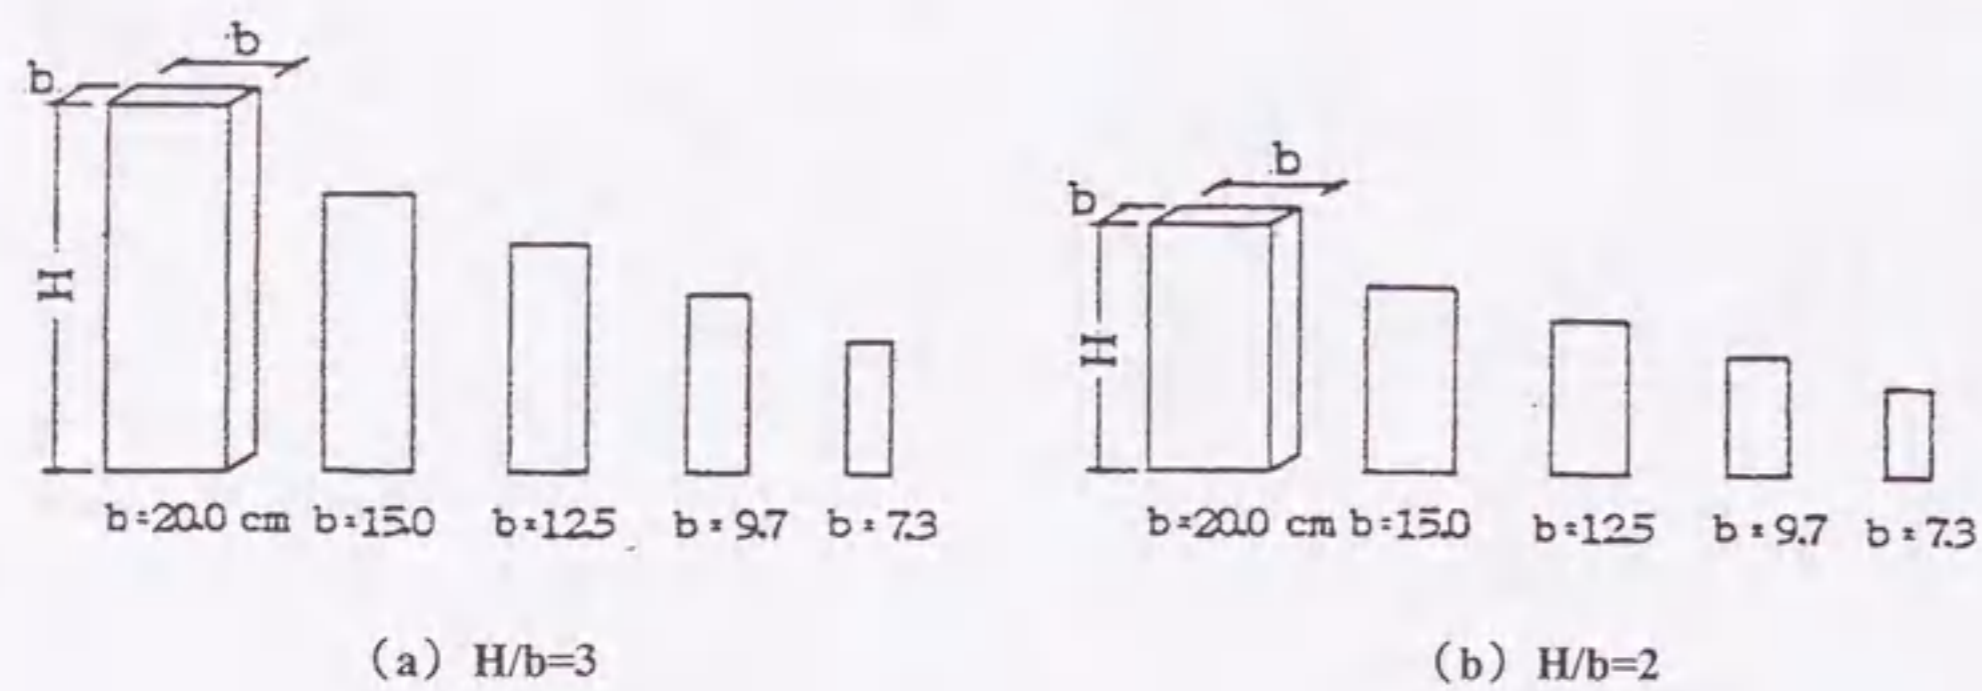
コンクリート角柱体の断面寸法 (実験II)
